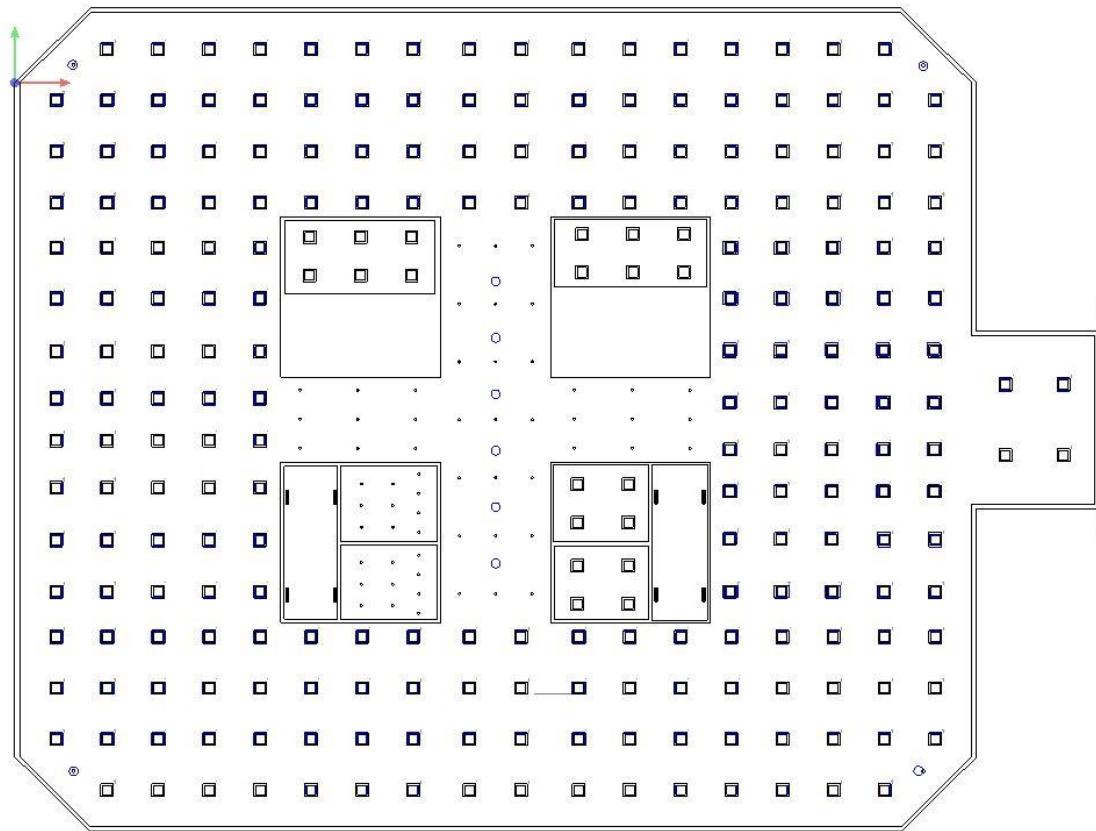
Vista en planta de Planta Tipo de Edificio de Oficinas.
